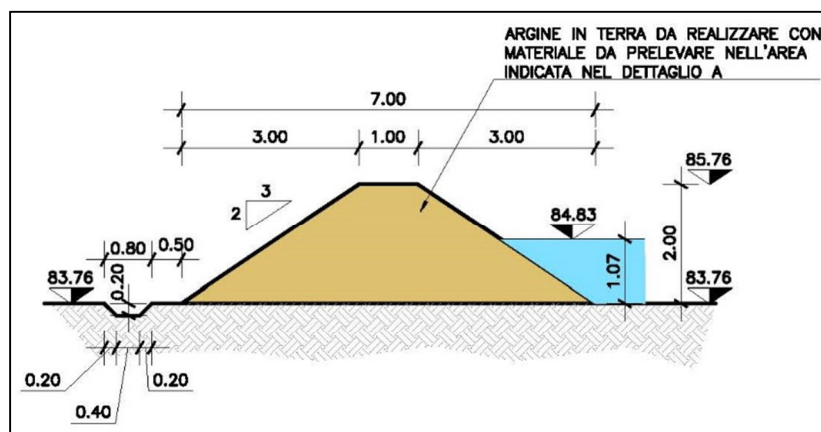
Argine - Stagione 1 - Sezione tipo
